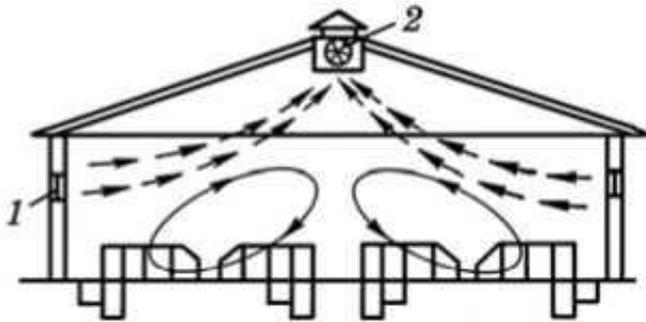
Вытяжная вентиляция помещений с вентиляторами, размещенными на крыше:
